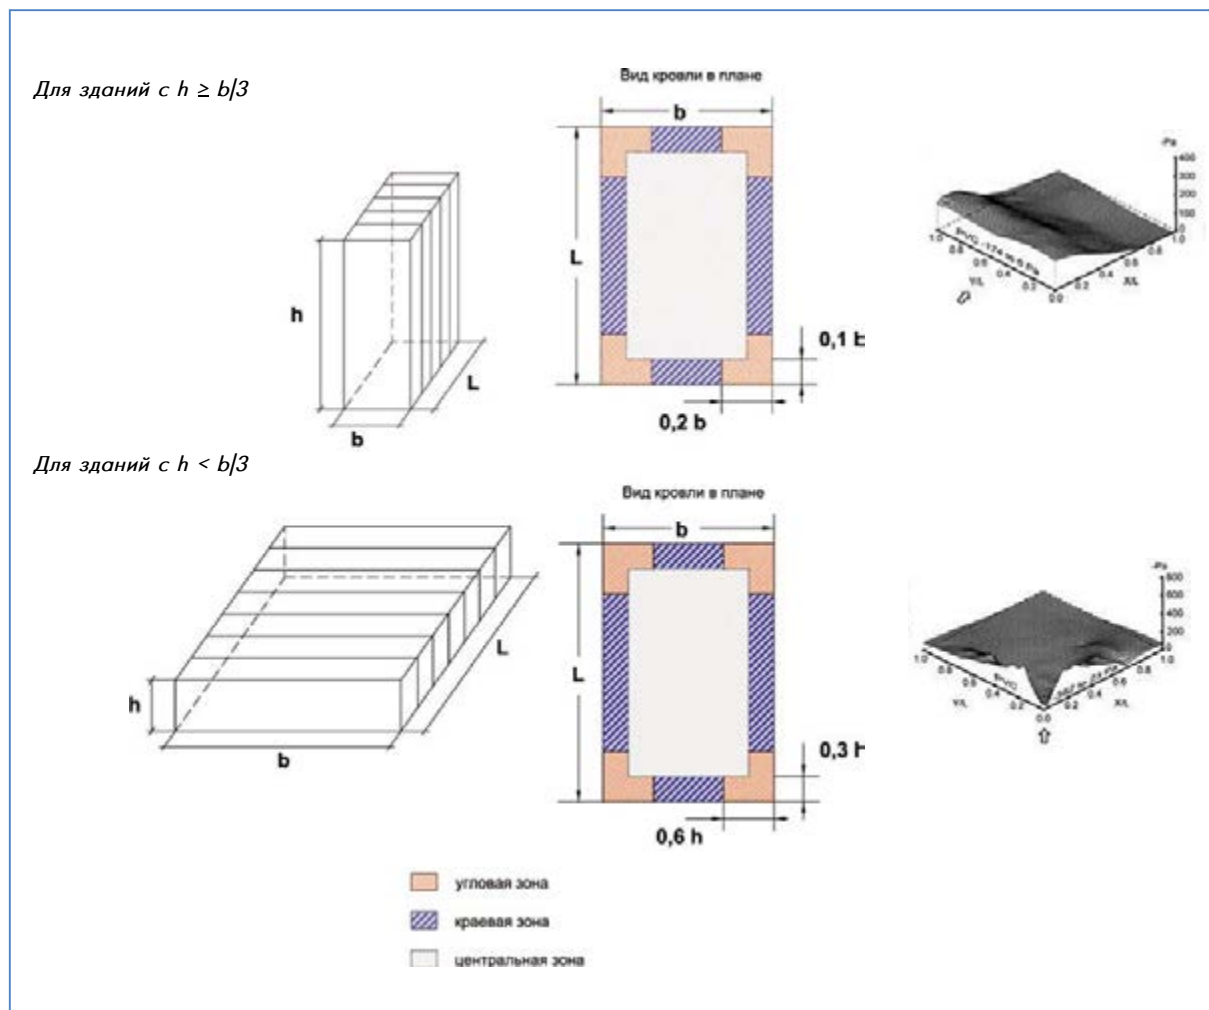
Деление кровли на зоны ветровой нагрузки.
